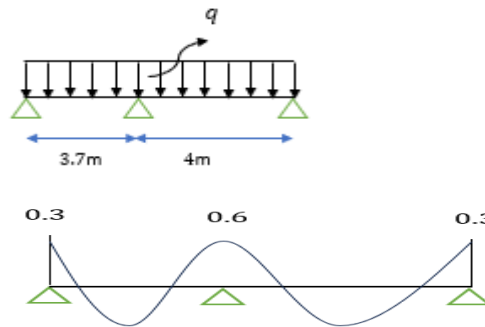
Schéma statique de la poutre appuyée sur 3 appuis.
